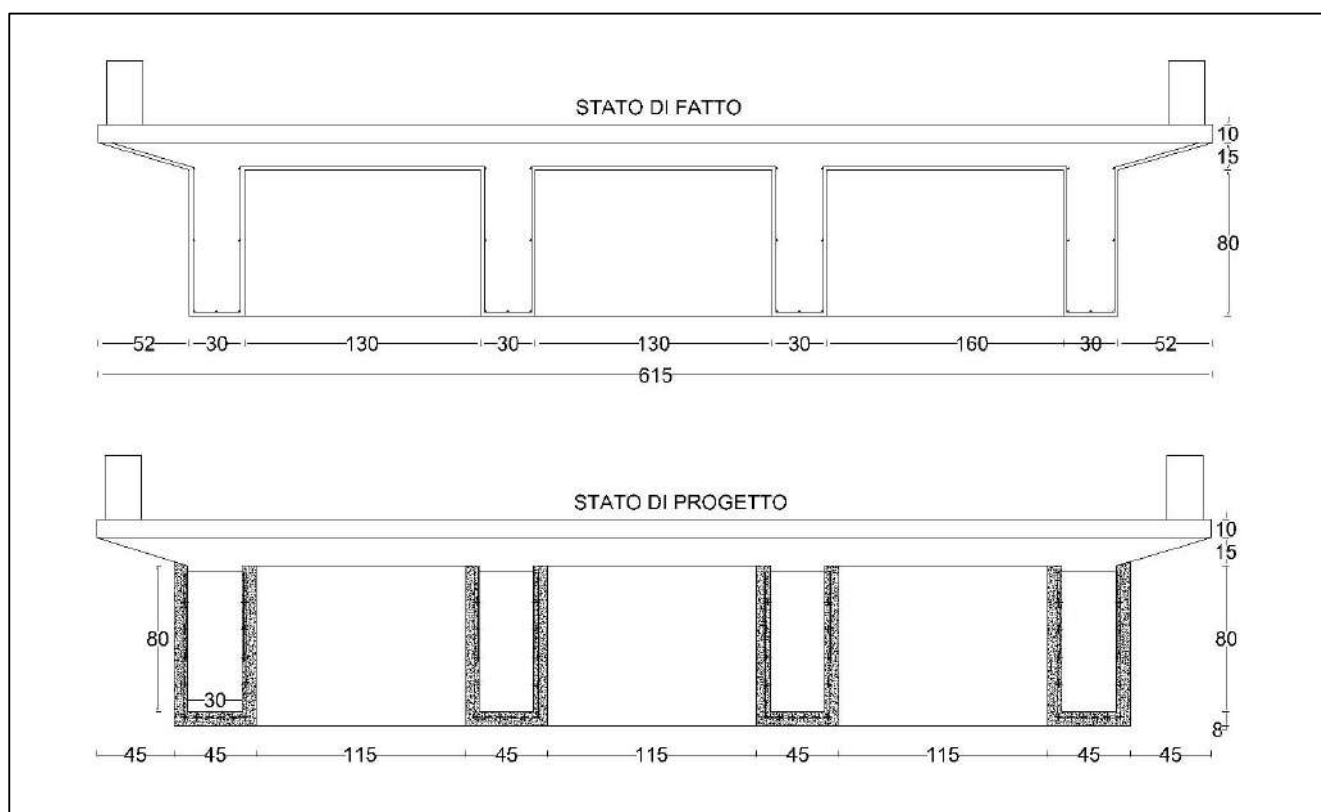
Sez. trasversale impalcato: stato di fatto e di progetto
